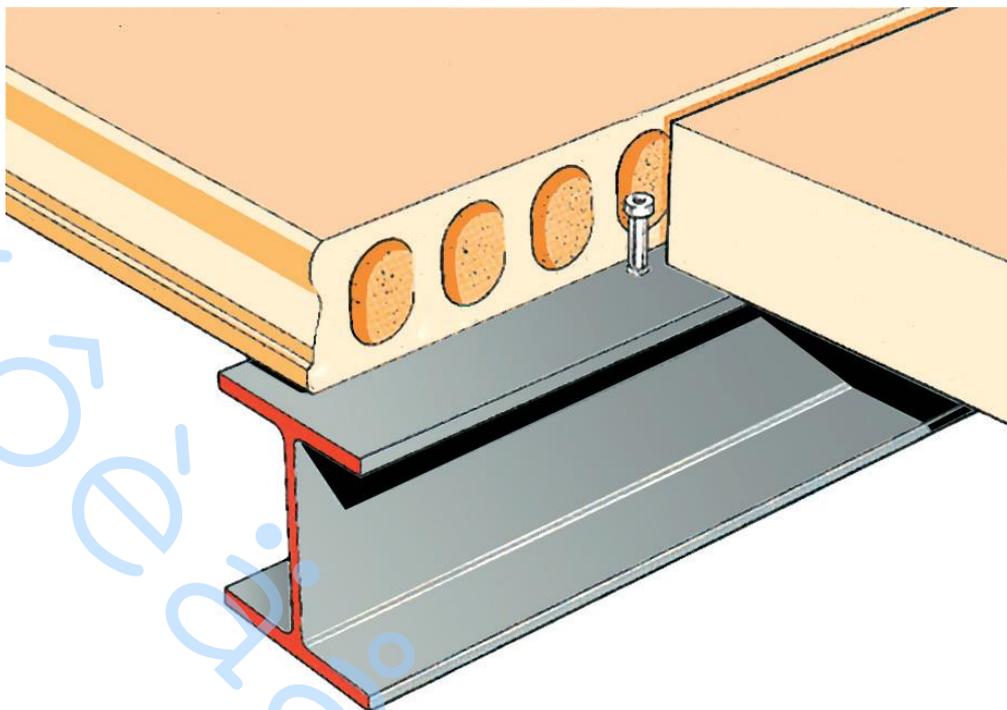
Фрагмент устройства сборного железобетонного перекрытия по металлическим балкам двутаврового сечения
